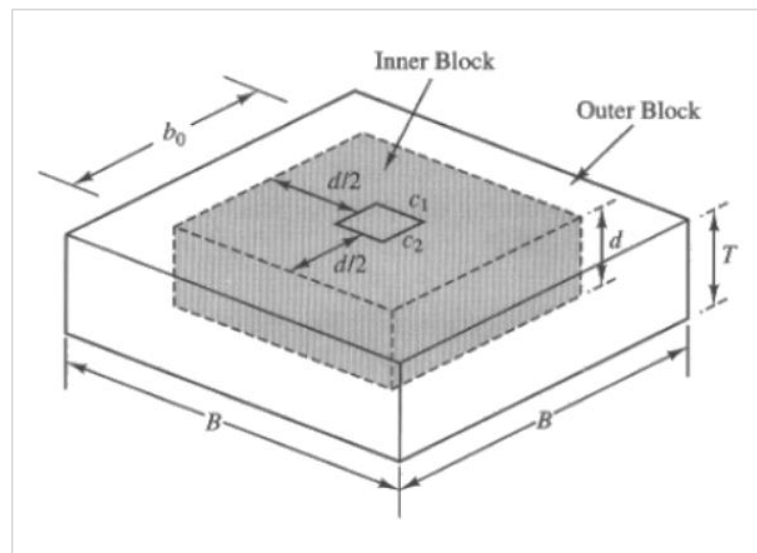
1 Bloques de corte en dos direcciones, de una zapata aislada.
